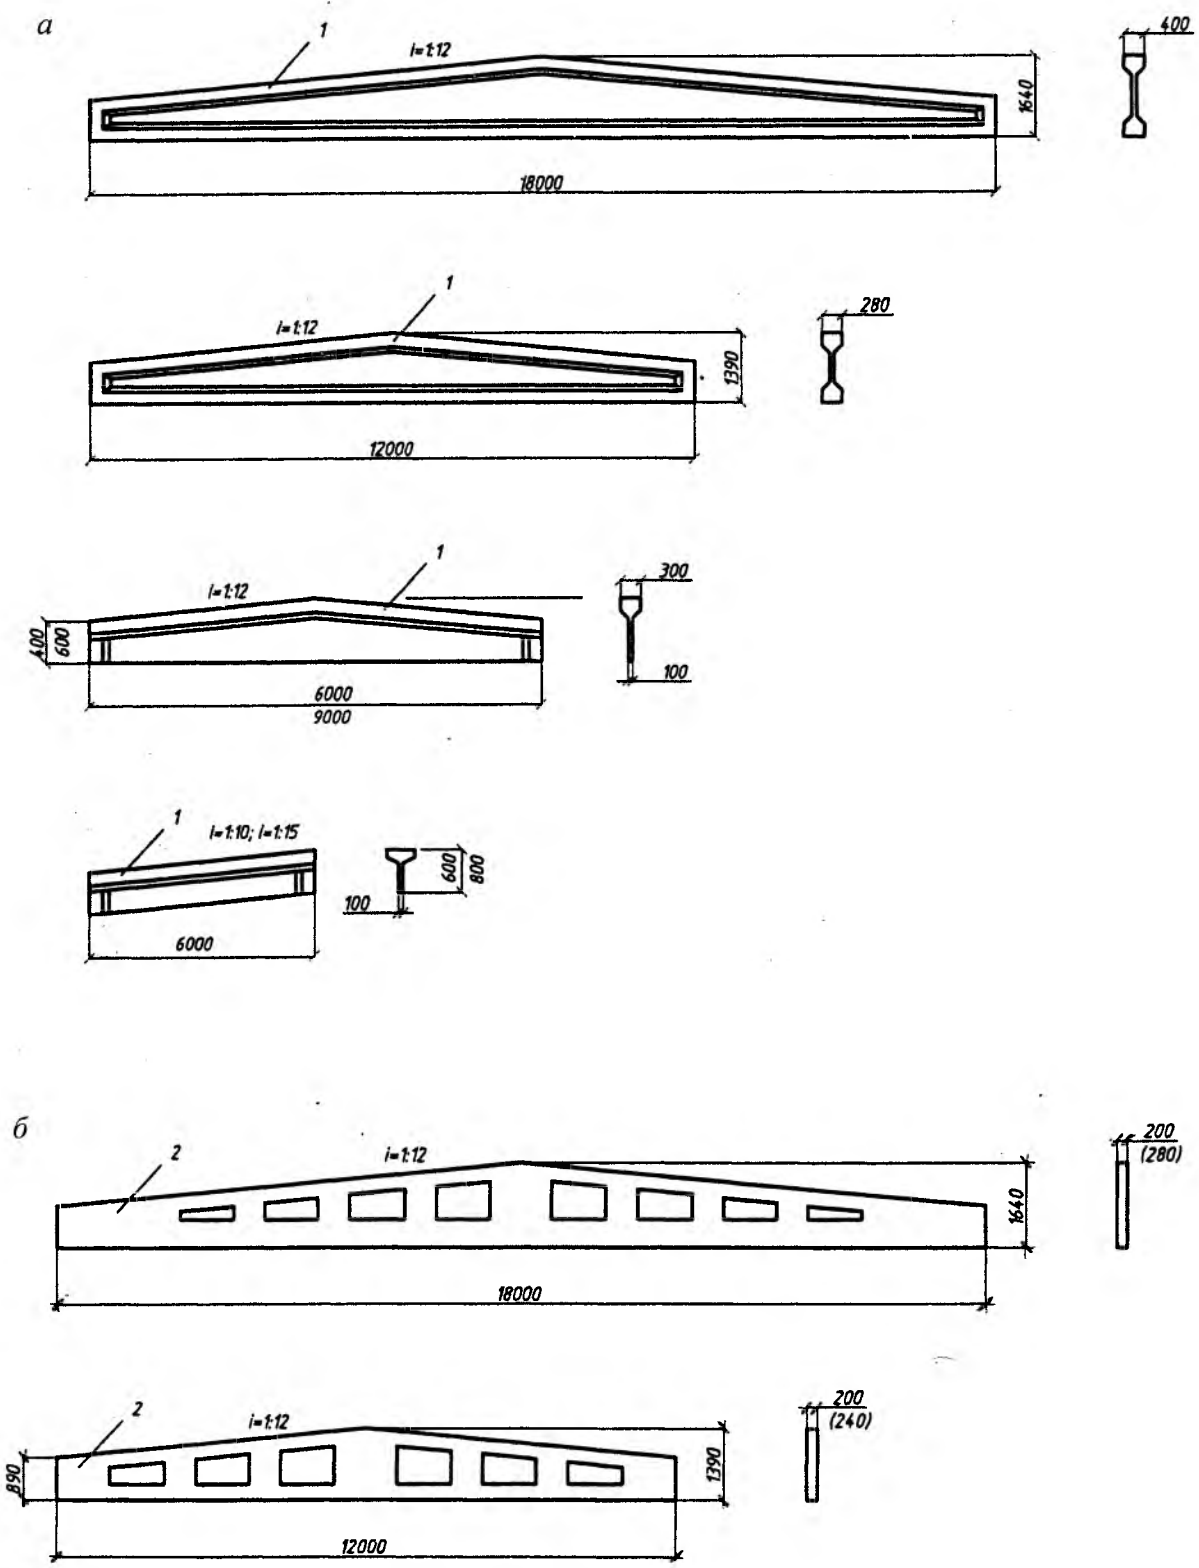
Железобетонные сборные унифицированные балки покрытий для скатов кровли:
